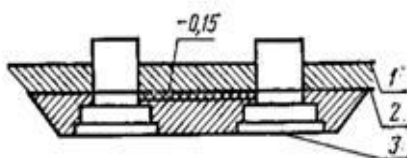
Схема разработки котлована с распределением доли грунта, относимой к различным сметам, когда на строительной площадке предусмотрена общая срезка грунта:
